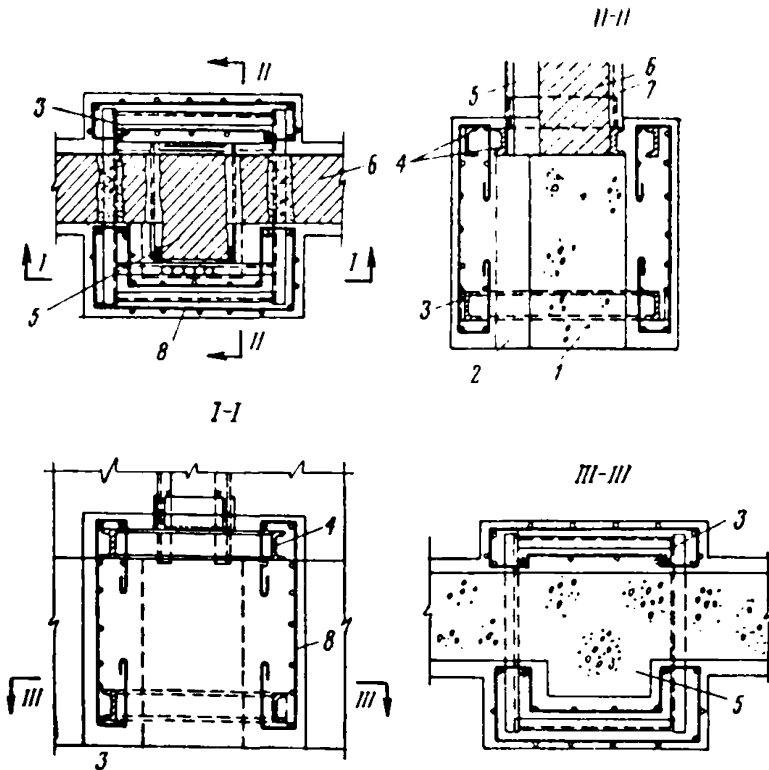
Усиление ленточных фундаментов железобетонной рубашкой
